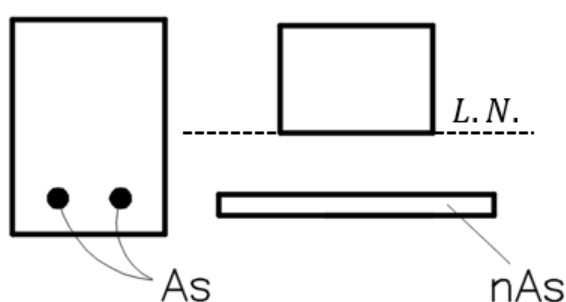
Seção transversal equivalente da viga de concreto armado. Fonte: O Autor (2016).
